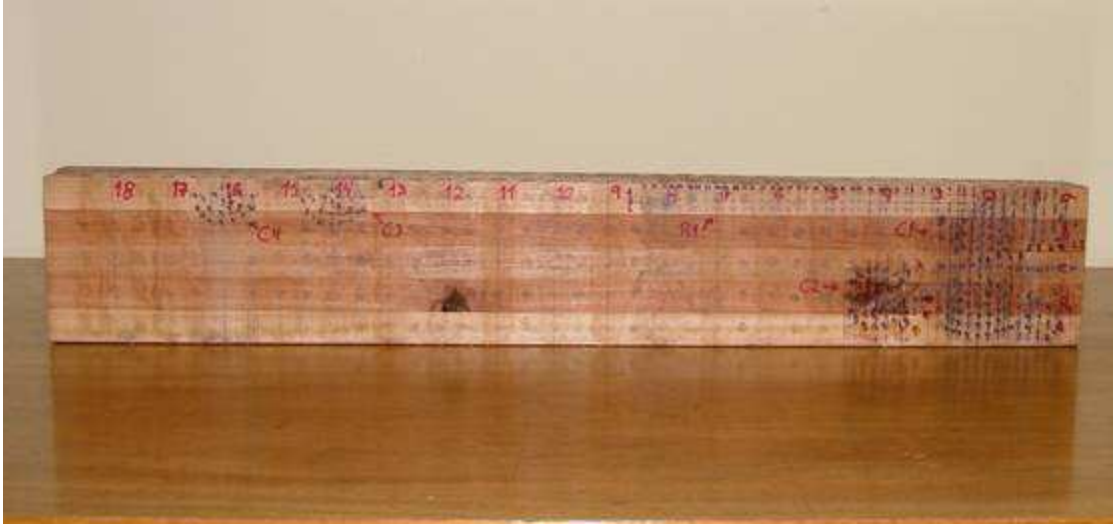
Viga de madeira laminada colada usada no Ensaio 1.
